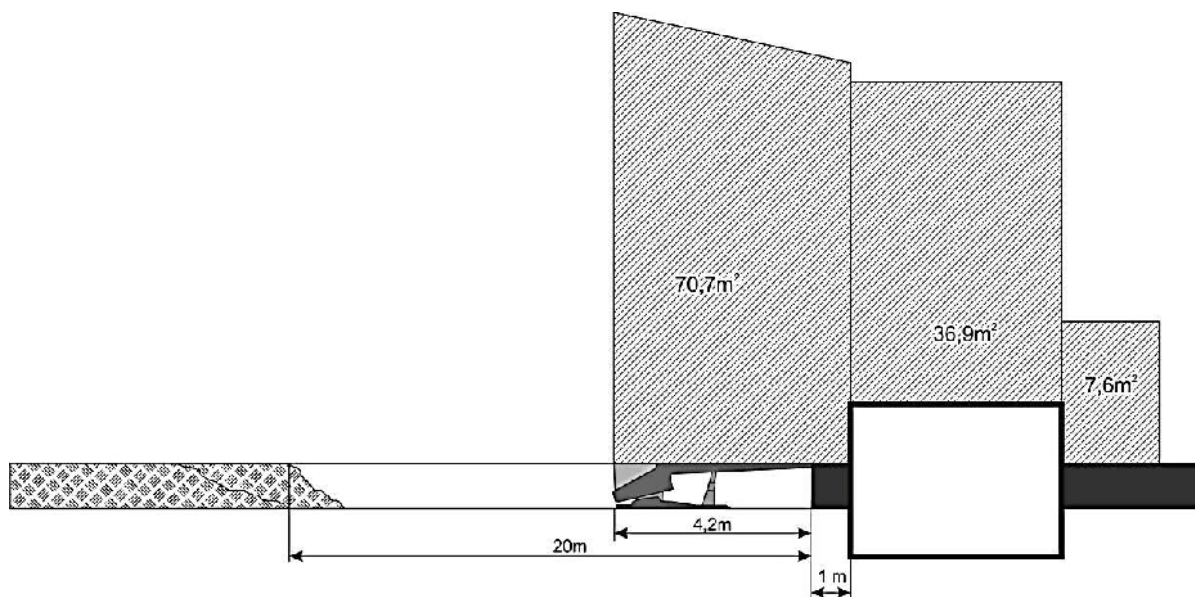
Площади зон разрушения в момент приближения лавы к демонтажной камере на расстояние 1 м (размер выработки 20 м)
